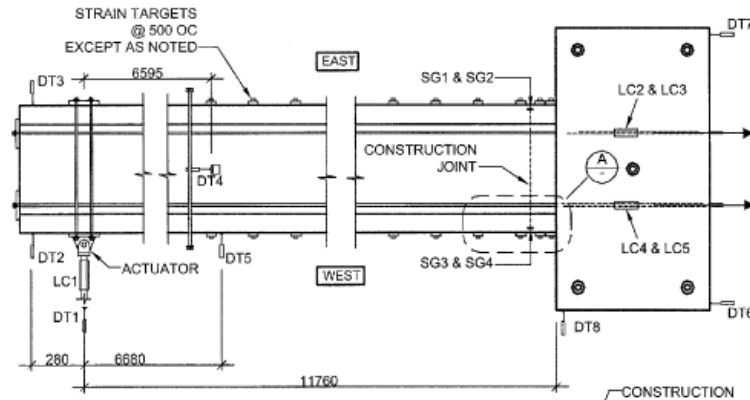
Vista lateral probeta muro, Adebar et al [20].
